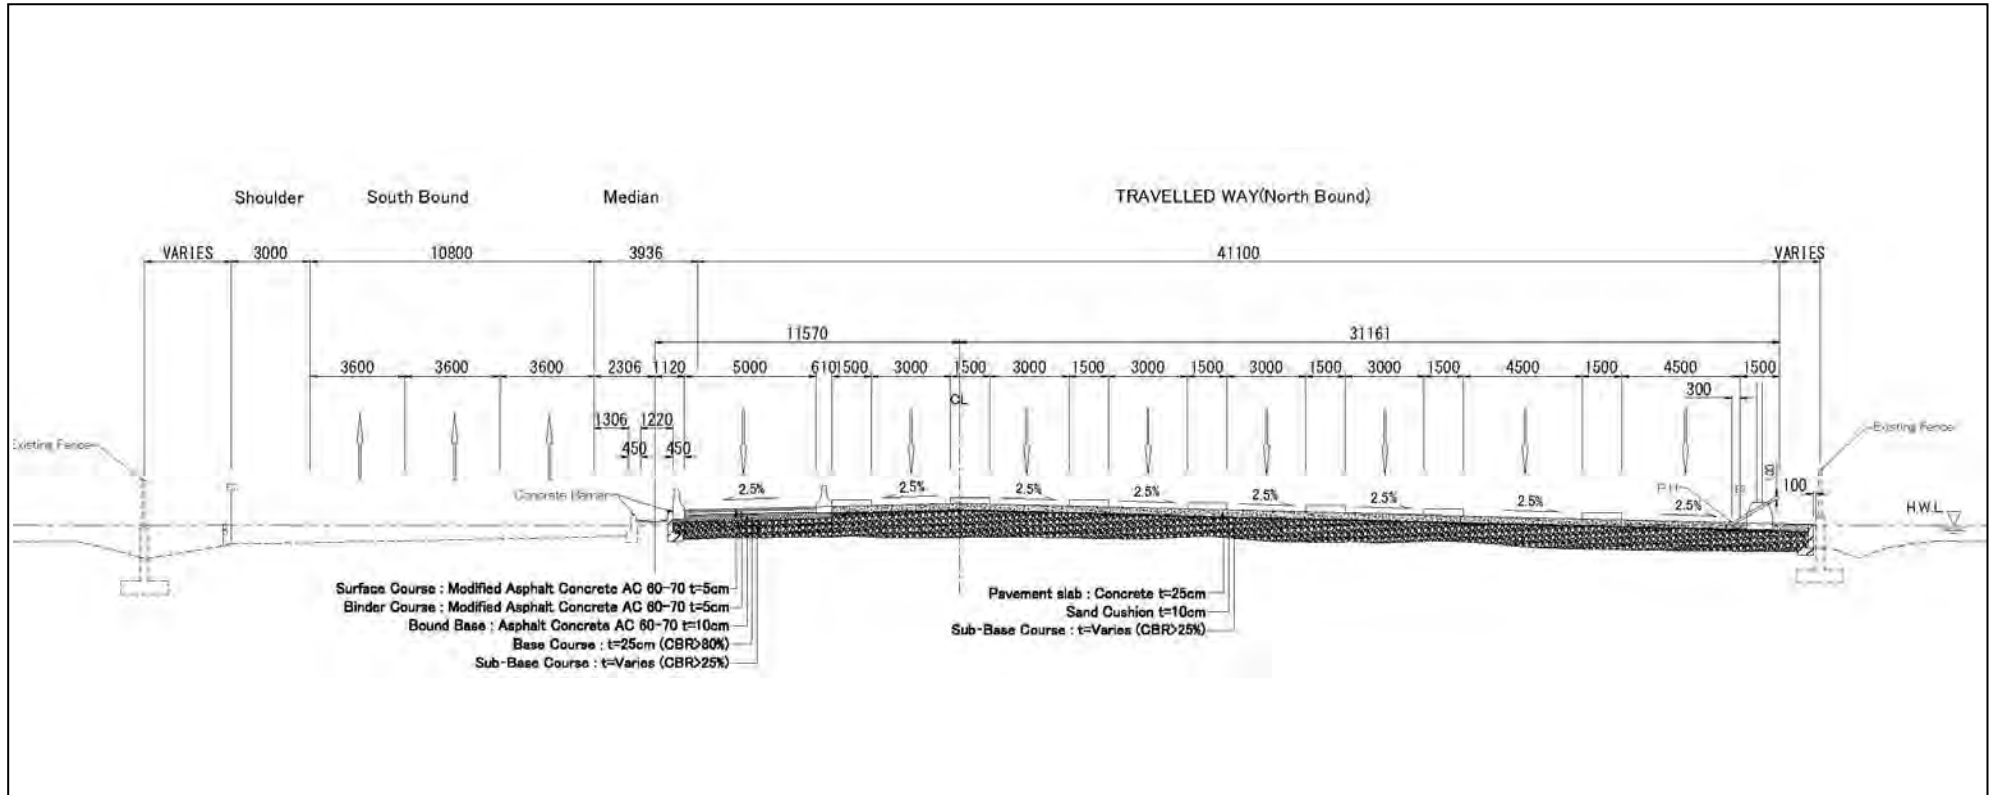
標準横断面図 (料金所区間の標準横断面図)
